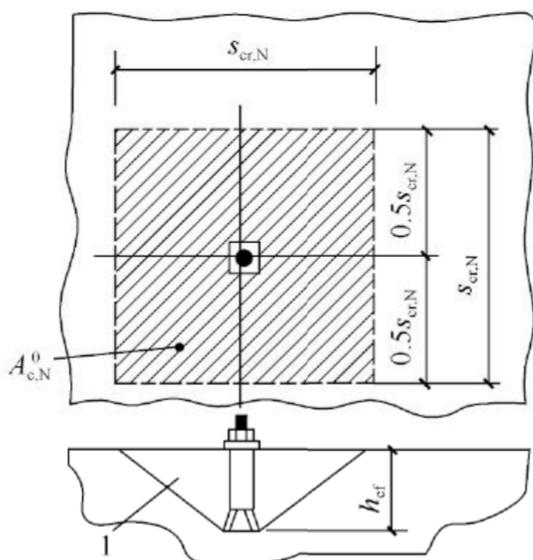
单锚混凝土锥形破坏理想锥体投影面积
